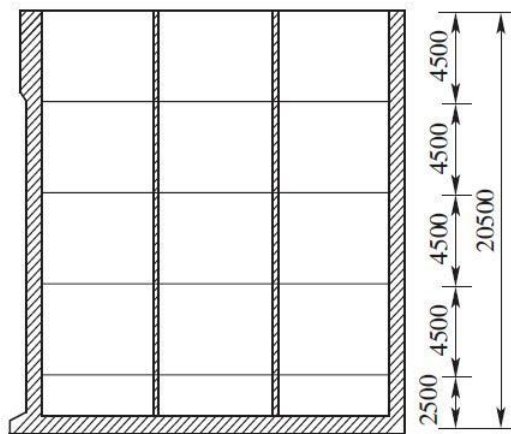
沉箱分层施工示意图（分层高度仅供参考）
